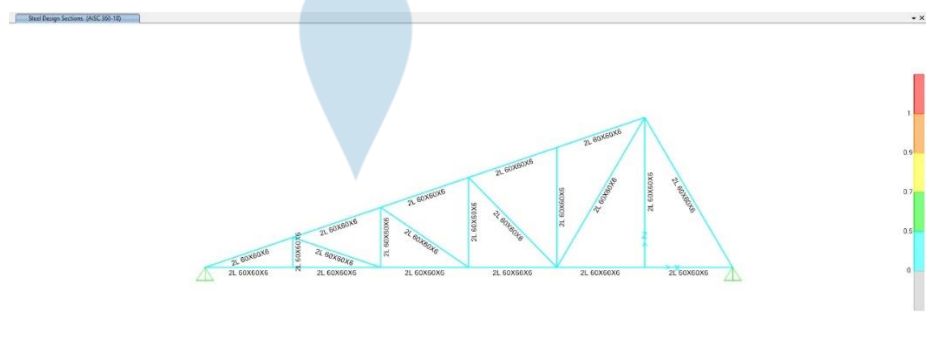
27 *Run* Atap Bangunan B (SAP 2000)
